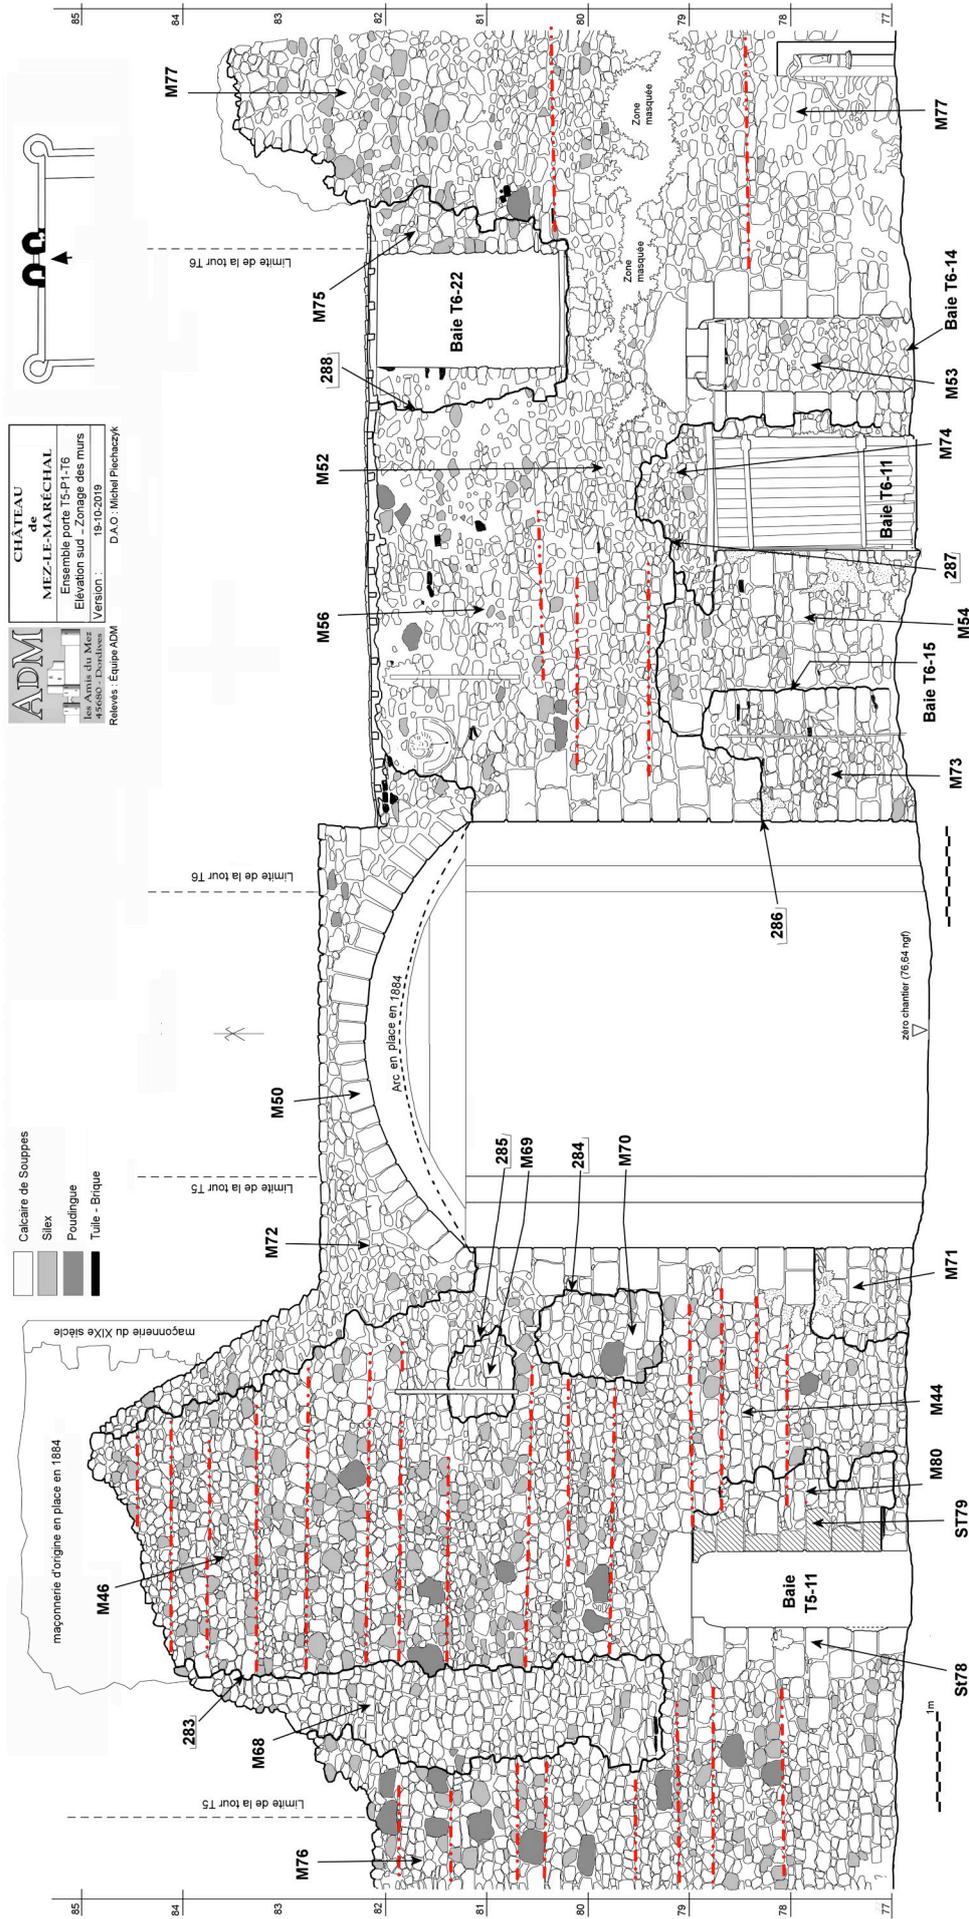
Relevé pierre à pierre de l'ensemble de la façade sud, d'après l'orthophotographie et photogrammétrie - Identification et numérotation des structures (DAO : Philippe Lefeuvre et Michel Piechaczyk /ADM).
